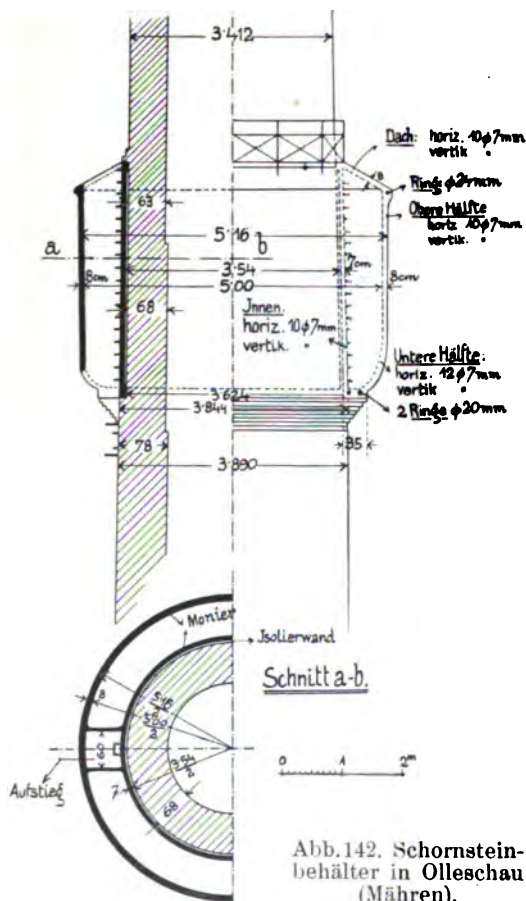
Schornsteinbehälter in Olleschau (Mähren).
